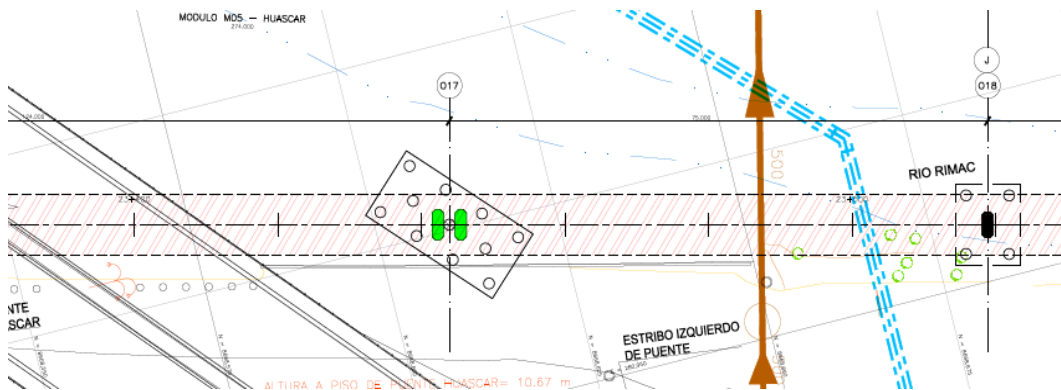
Pilotes en puente Sobre la vía de Evitamiento.
